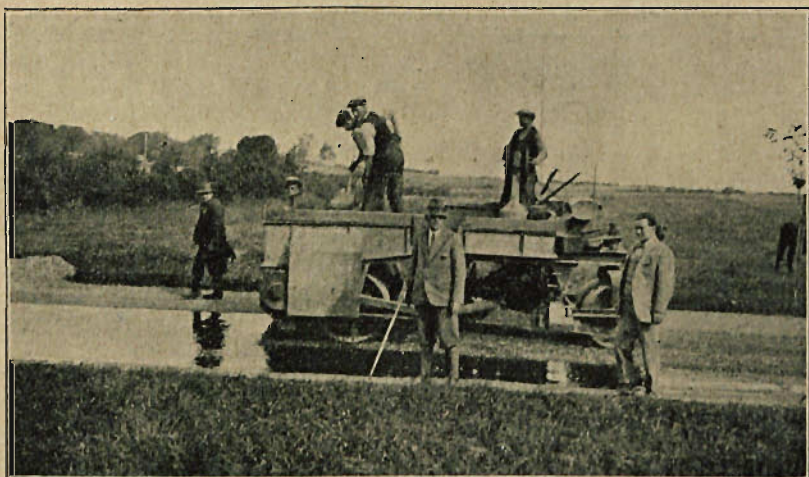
Nowy typ rozlewaczki Johnston'a z szczotkami.
